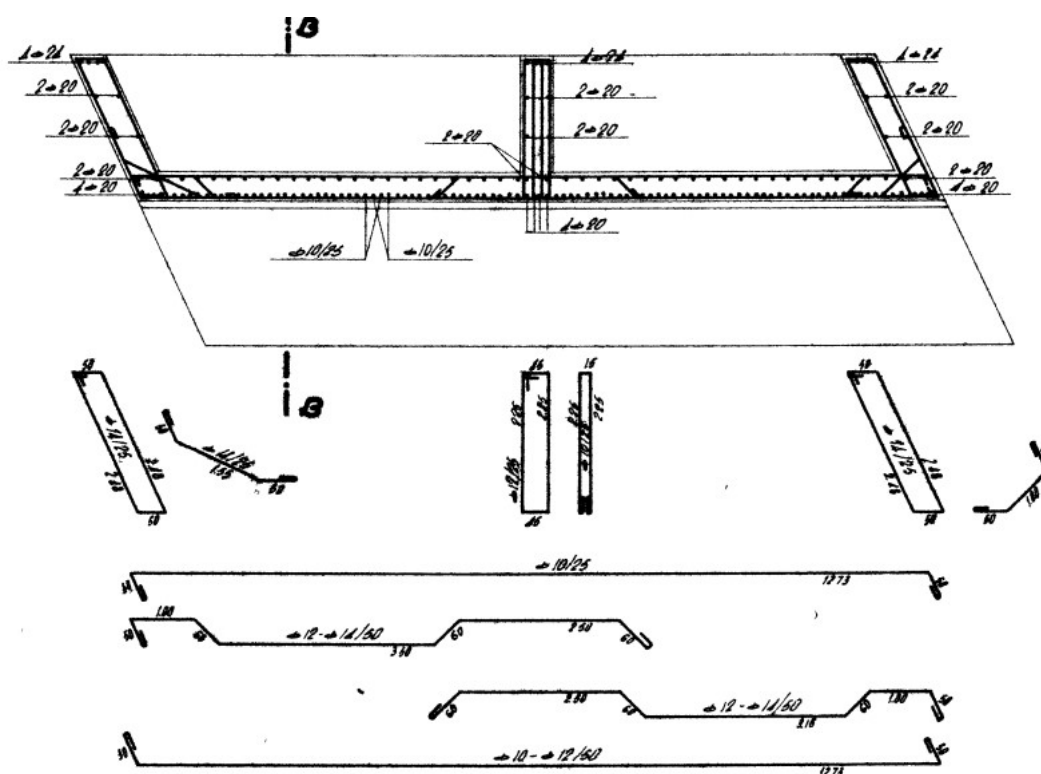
Documento as-built “Sottovia Interconnessione 1 dell’autostrada A14 al km 14+232” – Sezione orizzontale con armature spalla.
